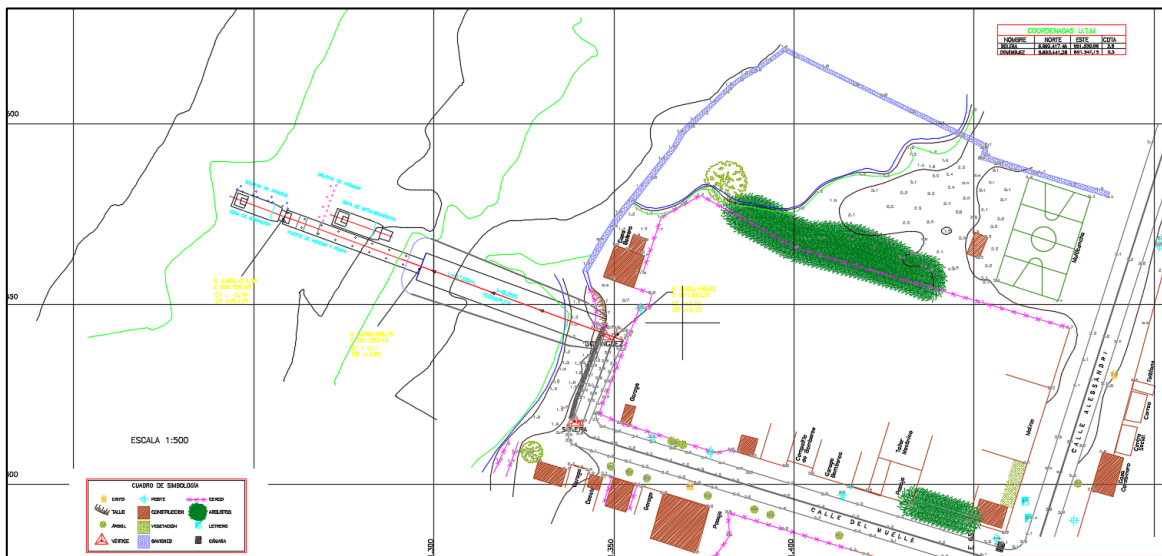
Plano de vista en planta del Puerto Domínguez
